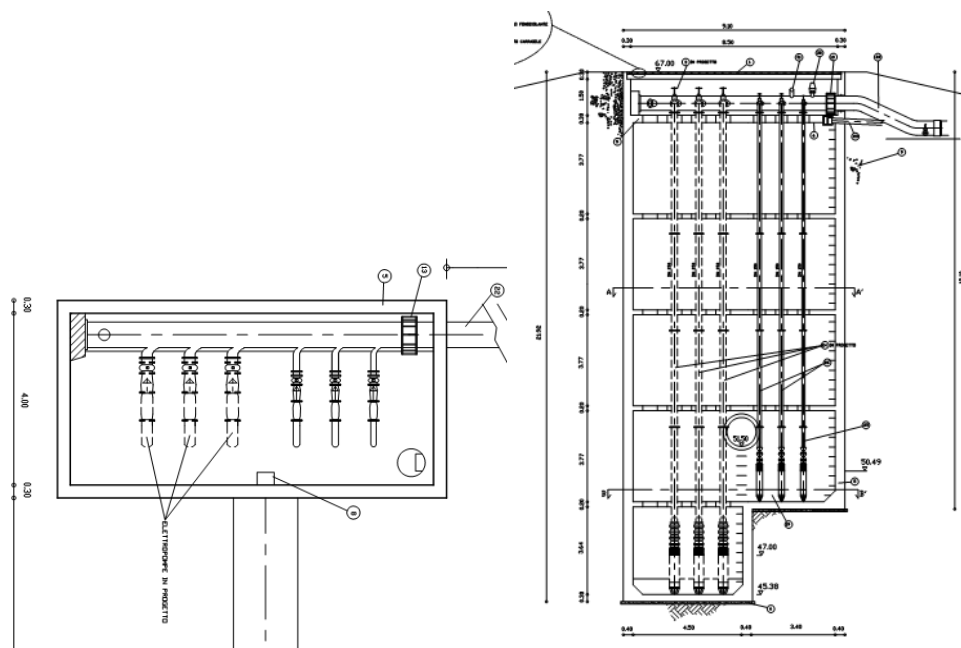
Pianta e sezione manufatto alloggiamento pompe
